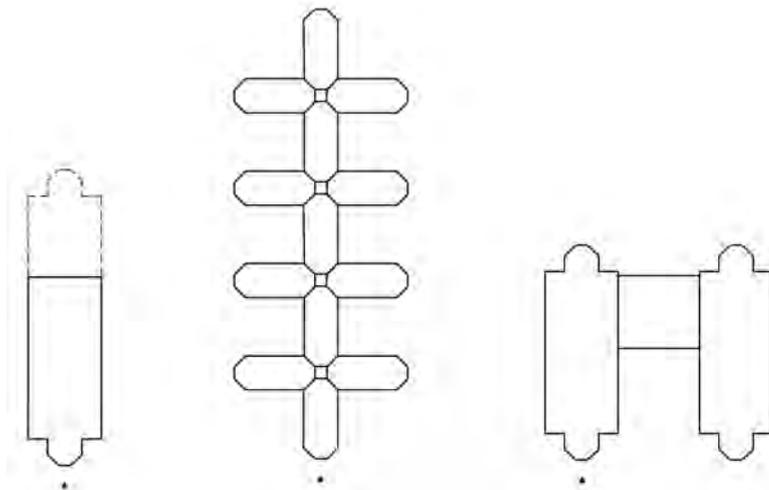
Grundrissvarianten mit DRASH-Shelter, drei Beispiele. Maßstab 1:1000. Eigene Darstellung.
